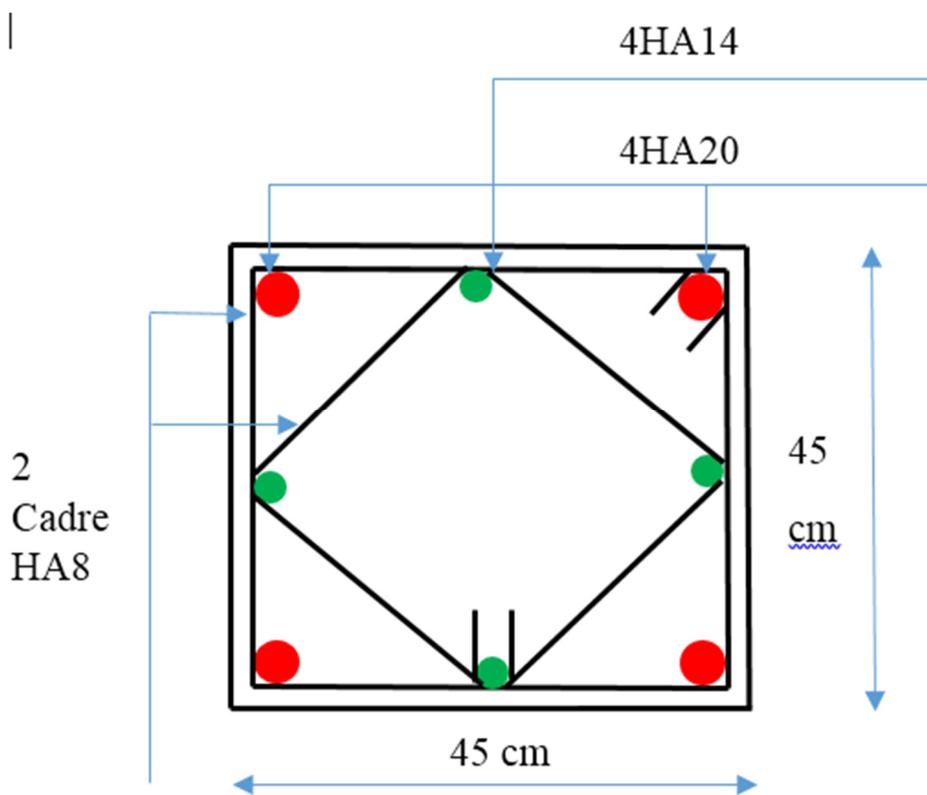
Schéma de ferrailage des poteaux (45x45)
